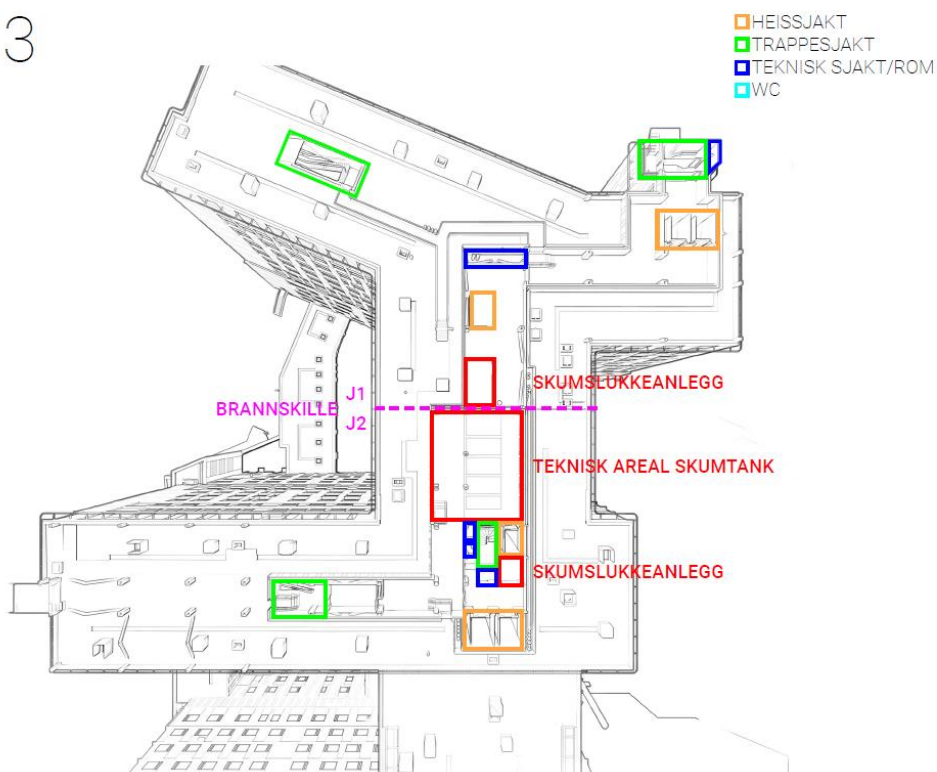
og Figur 4-12 er plantegninger for hhv. plan 14 og 13. Figurene illustrerer plassering av brannseksjonering mellom J1 og J2, plassering av trappesjakter og akuttheisen på plan 14. På plan 13 finner vi alternative heissjakter, som kan benyttes dersom akuttheisen fra plan 14 er utilgjengelig. Kontrollrommet for helipadene, samt lager/beredskap er plassert på plan 14. Skumslokkeanlegg og tank for oppsamling av slokkeskum etter aktivering finnes på plan 13. Denne løsningen gir anledning til å teste skumslokkeanlegget og samle opp væsken.
